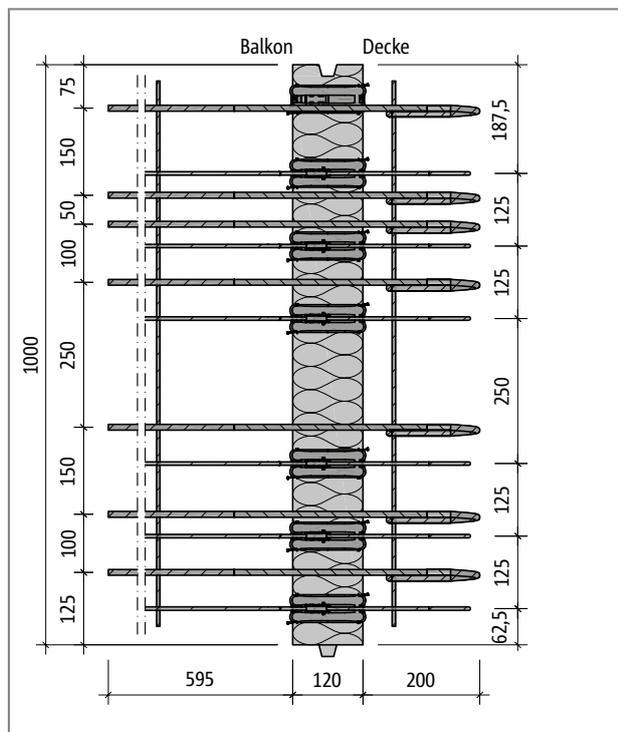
Schöck Isokorb® Typ KXT30-WO: Produktgrundriss
